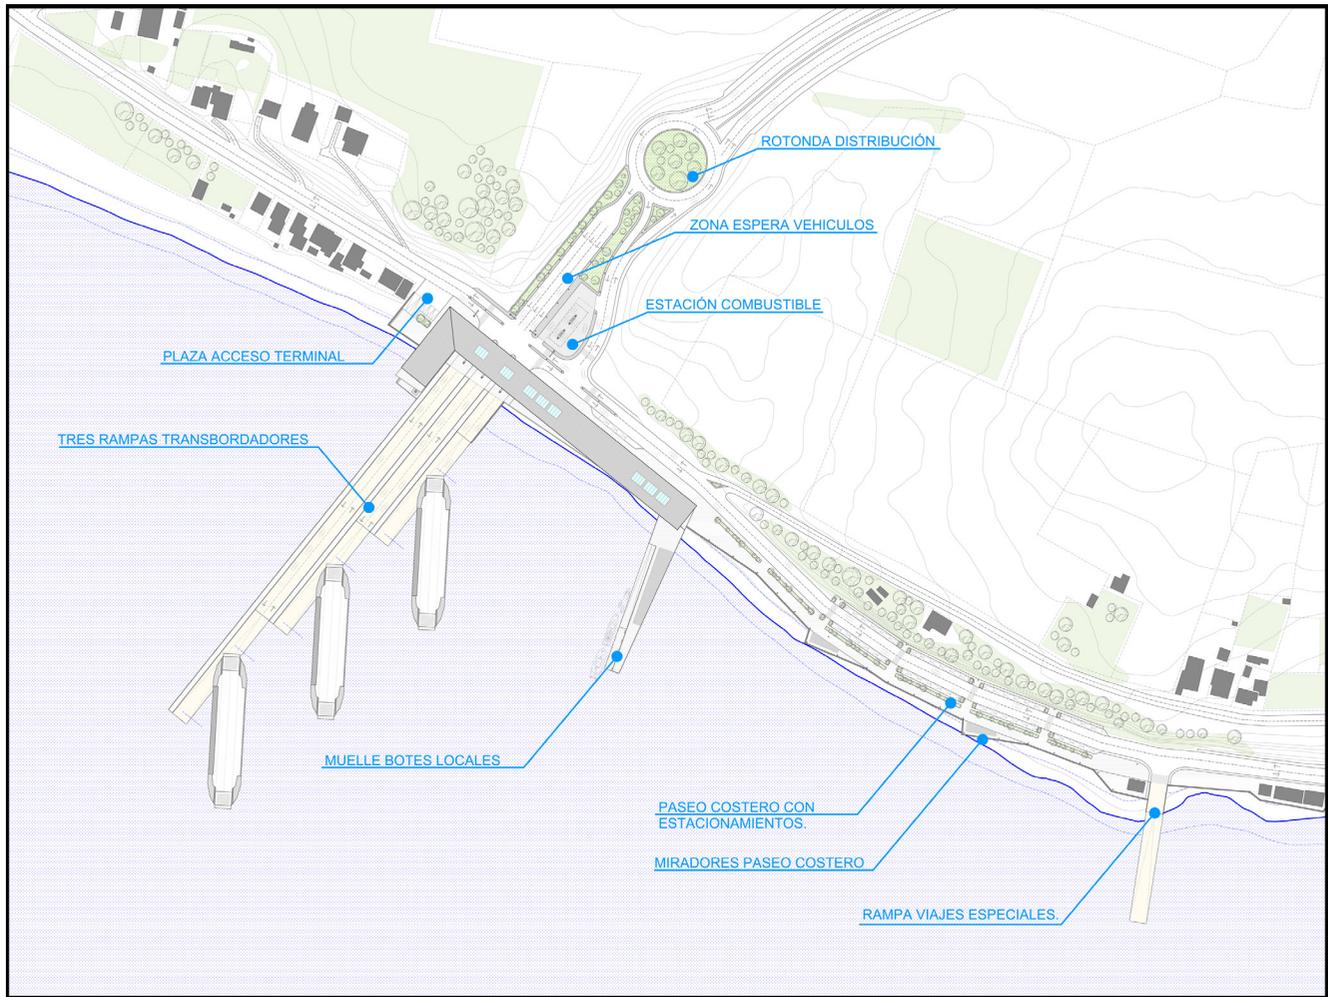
Planimetría Contexto Proyecto Terminal Puertas de Chiloé.
